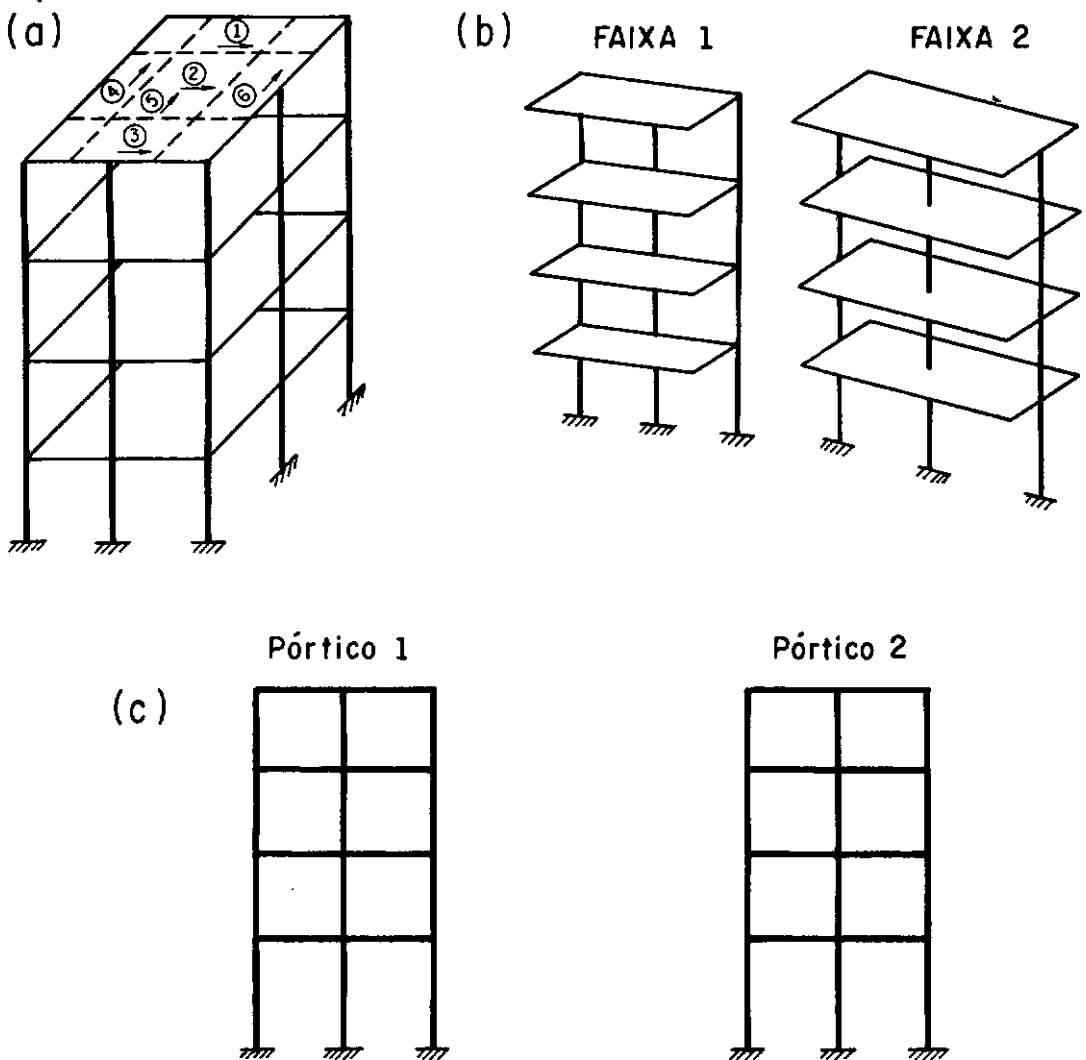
Idealização do conjunto de Pórticos Planos.
